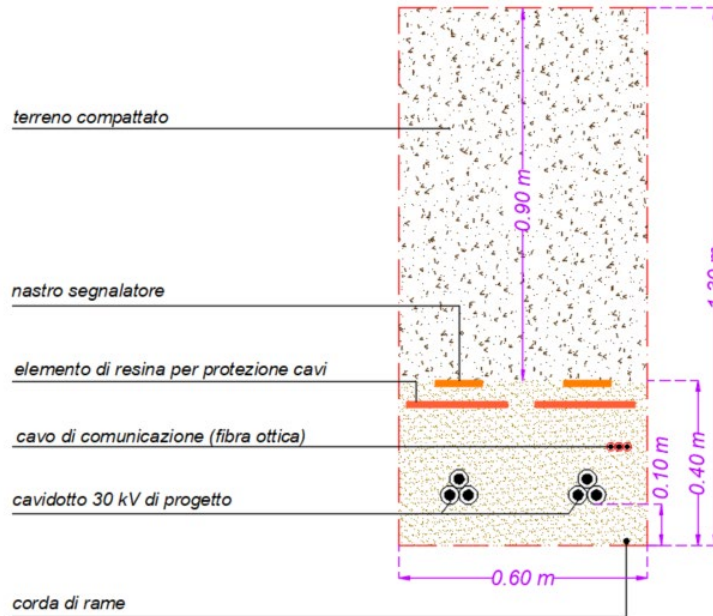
Sezione Cavidotto Doppia Terna su Terreno
